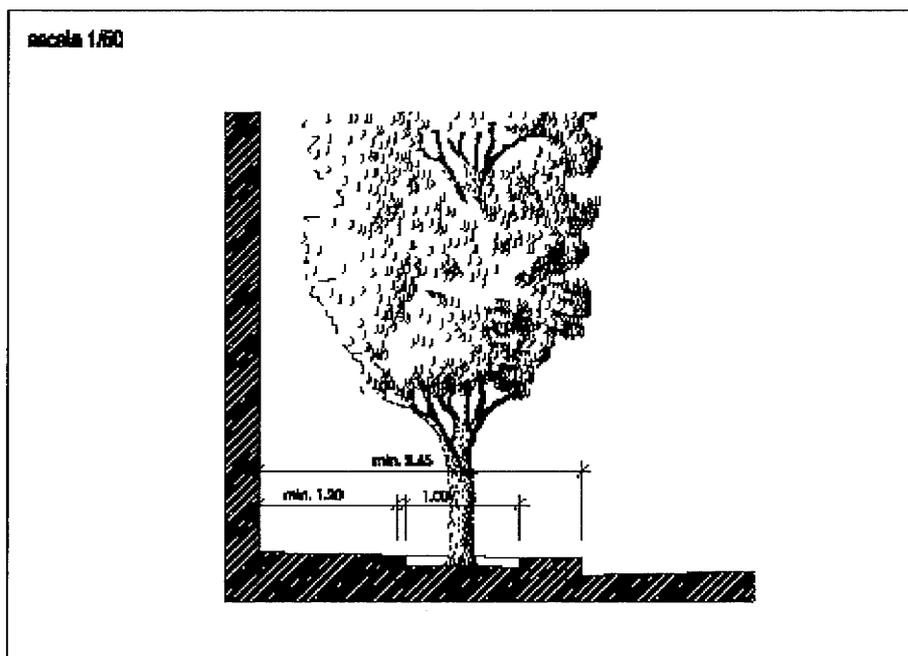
UTILIZAÇÃO DO SUBSOLO - PERFIL TIPO
